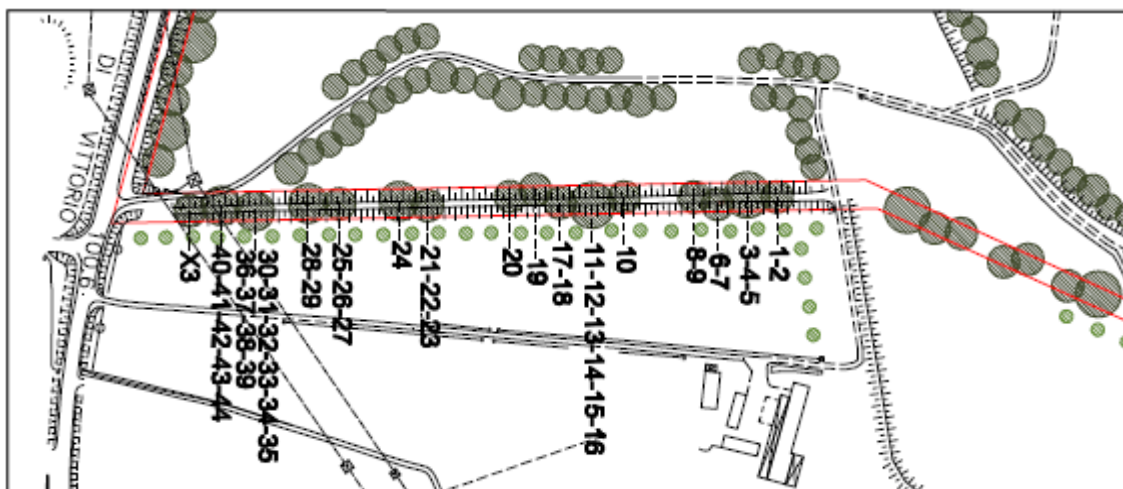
Schematizzazione in pianta del terreno con localizzazione alberi secondo filare (non in scala)
